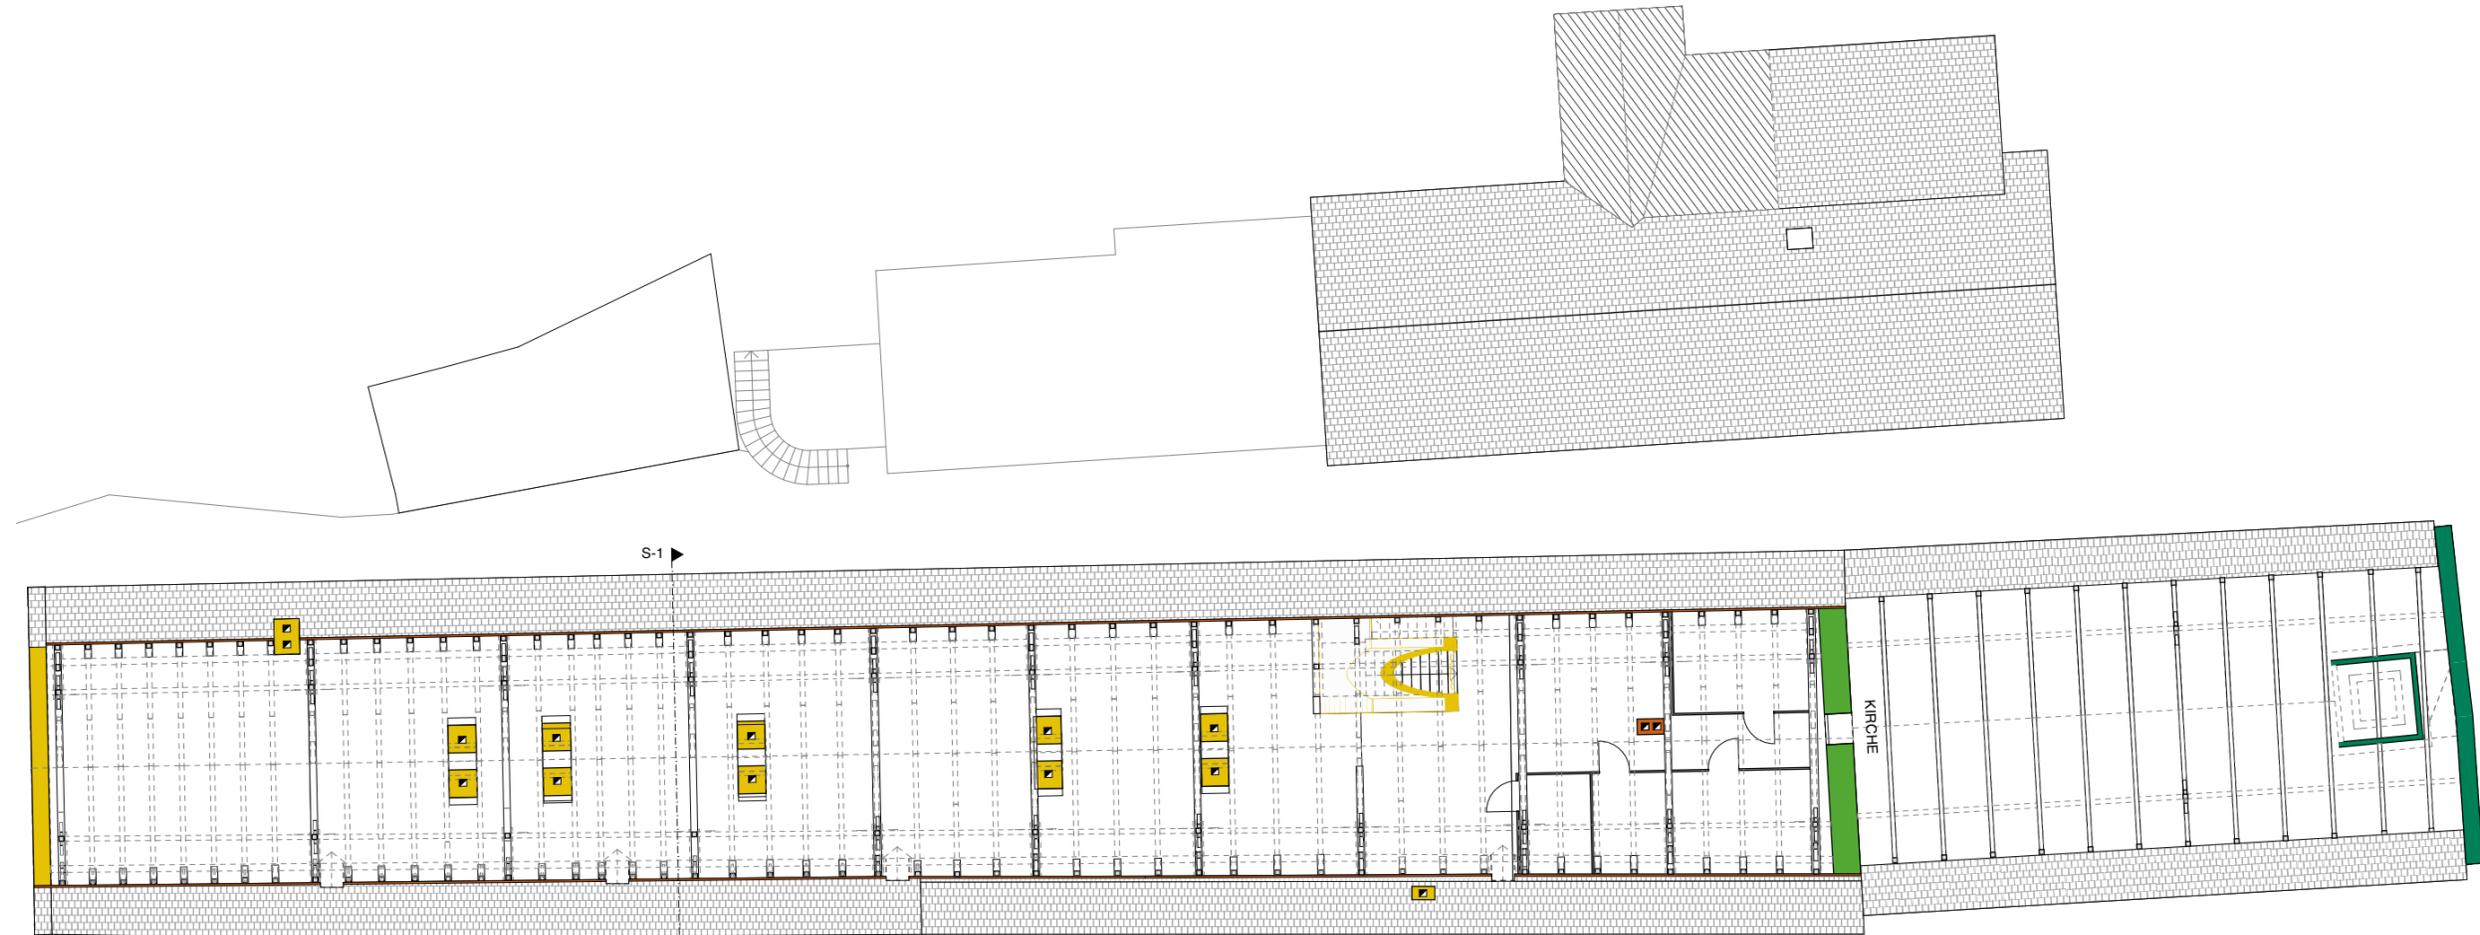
Baualtersplan. Obergeschoss Spitalstrakt und Spitalkirche, Dachboden Wirtschaftstrakt
